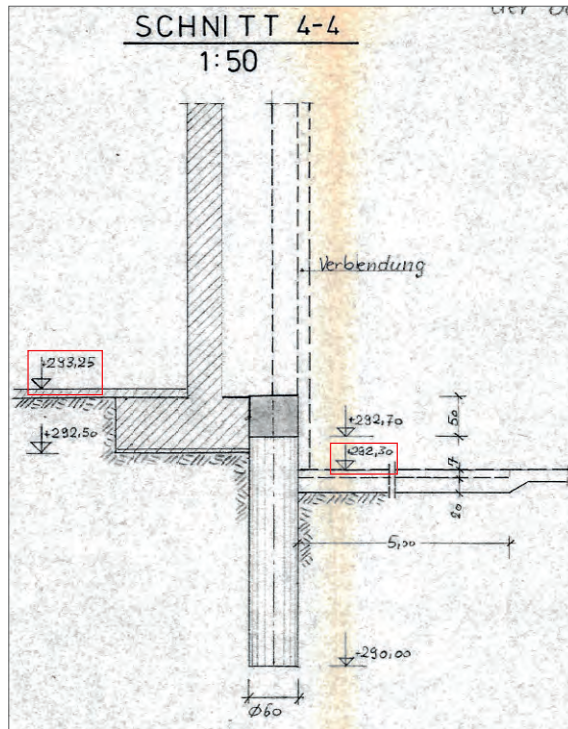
Lageplan und Schnitte mit Angaben zur Verankerung und zum Verbau/Bilfinger + Berger Bau AG (Auszug) [15c]
